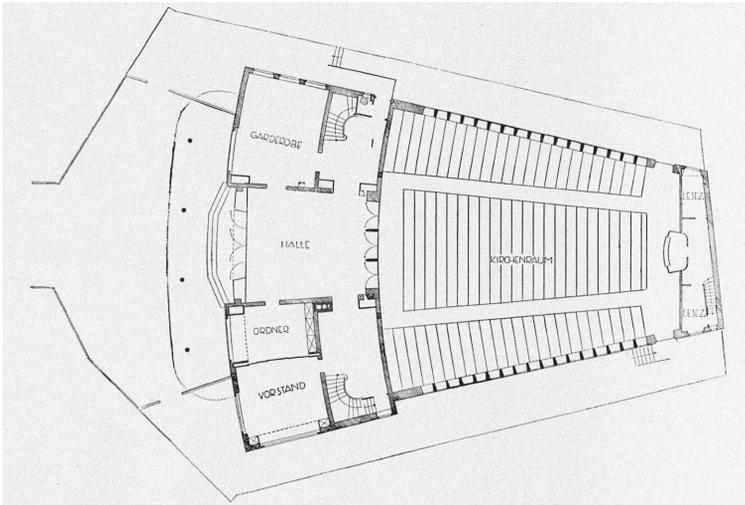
O.R. Salvisberg, Grundriss des Erdgeschosses der First Church of Christ, Scientist, Basel, in: *Moderne Bauformen. Monatshefte für Architektur und Raumkunst*, 36 (1937), S. 460
